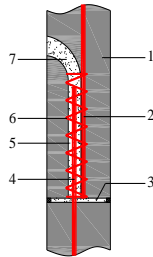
采用改进型钢筋浆锚连接构造示意图
